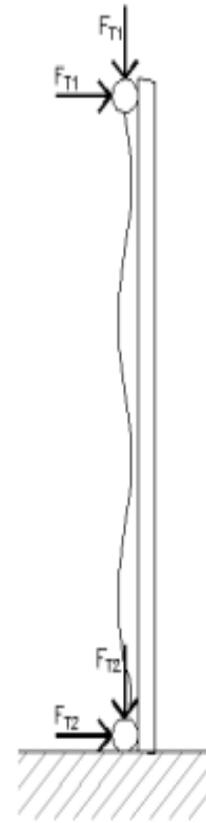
Cargas de serviço – Alternativa 2, cargas atuando separadamente
